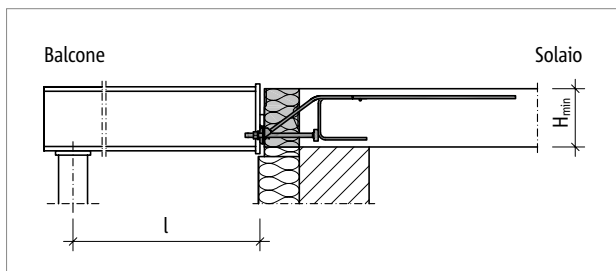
Schöck Isokorb® XT tipo SQP: schema statico
